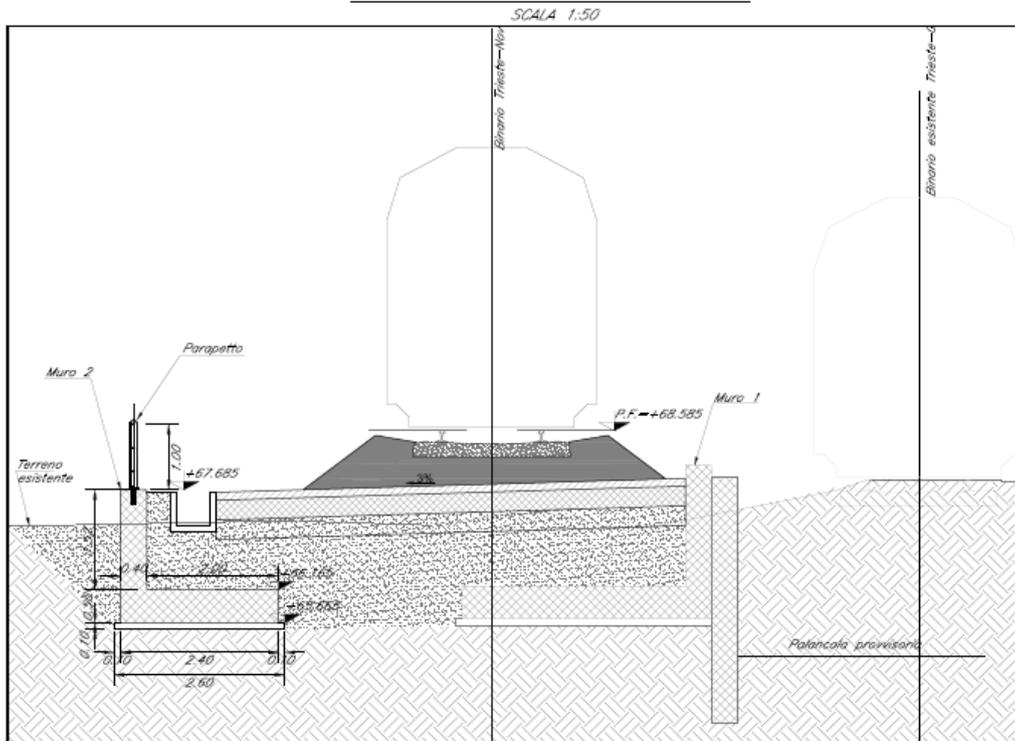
MU02 - Sezione trasversale Sezione longitudinale VI01
